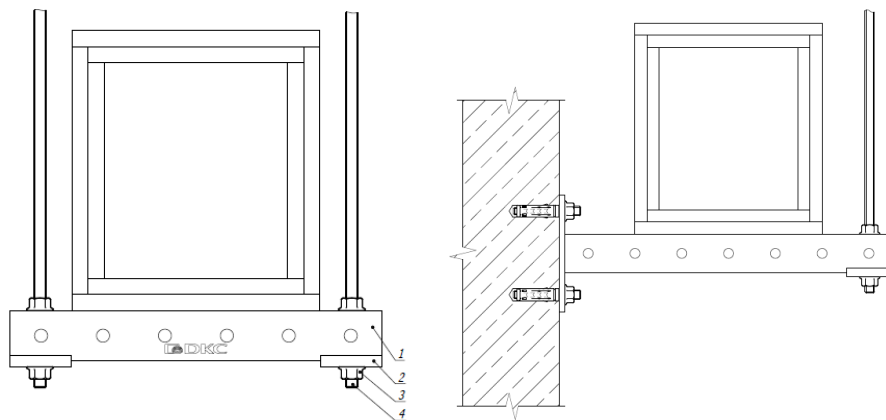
Крепление короба с четырьмя стенками к несущей поверхности
